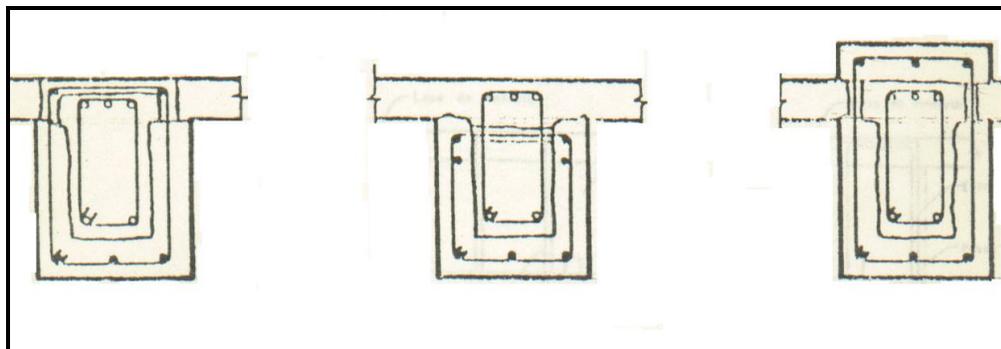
Encamisado por flexión y cortante de vigas de concreto reforzado¹⁷.
